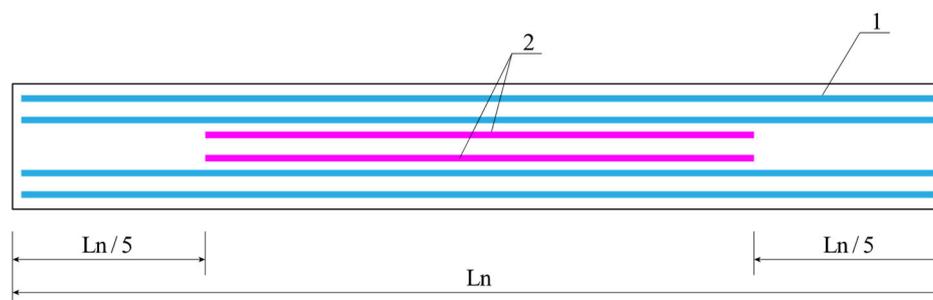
预制梁下部纵向普通钢筋构造要求
